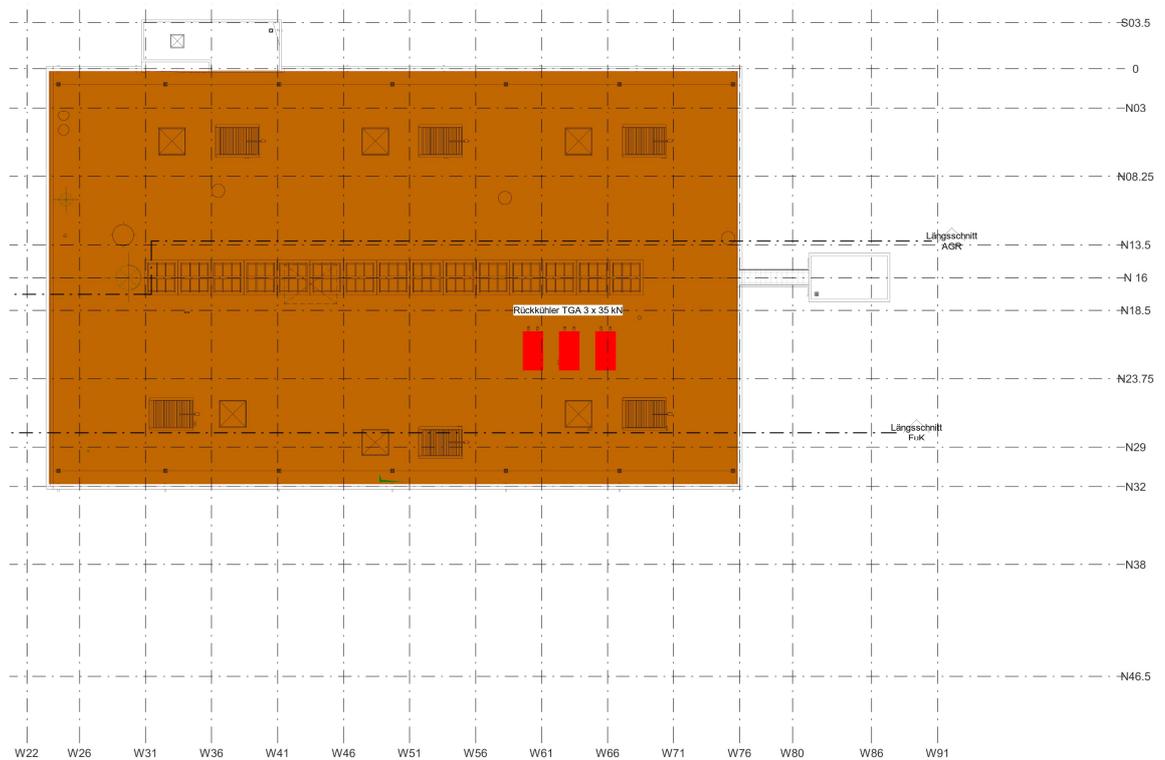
Nutzlasten Grundriss Dachansicht
